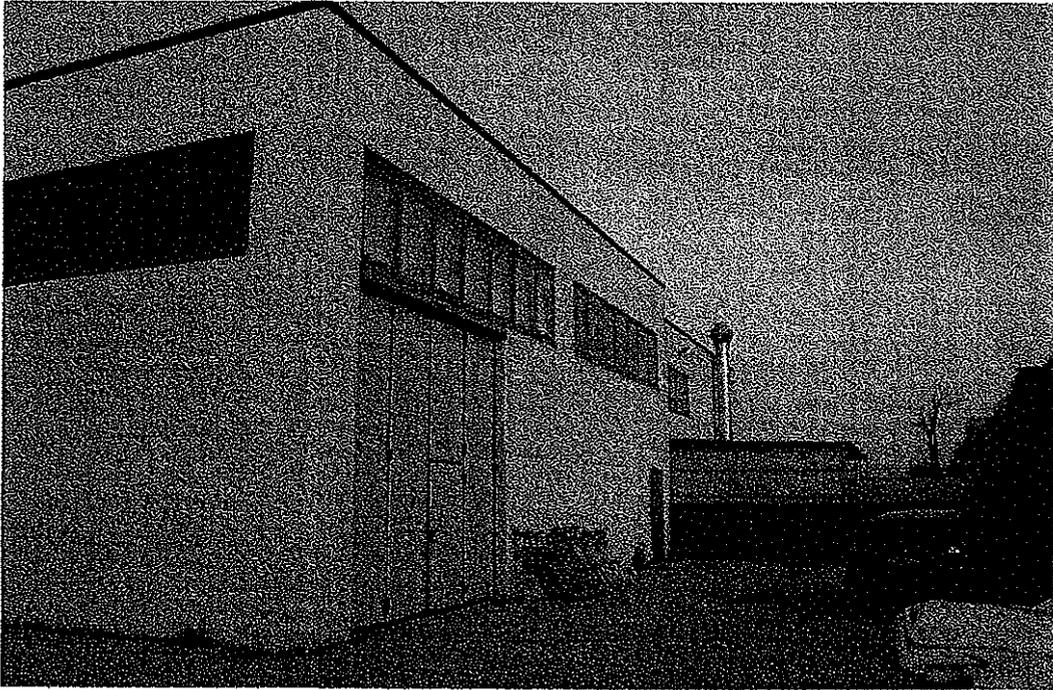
Vista dall'interno della corte - Particella 914 sub 4
